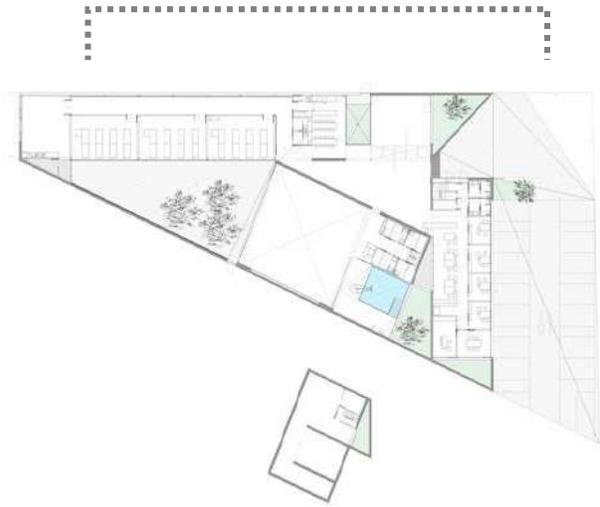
planta arquitectónica centro para personas con discapacidad
